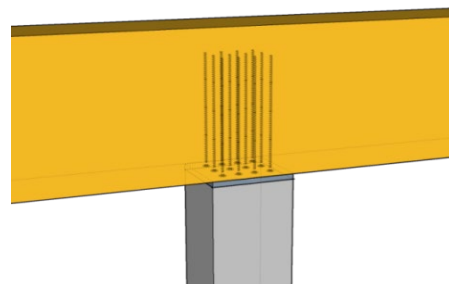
Prinzipskizzen zu Anschlüssen mit Schrauben und eingedrehten Gewindestangen
